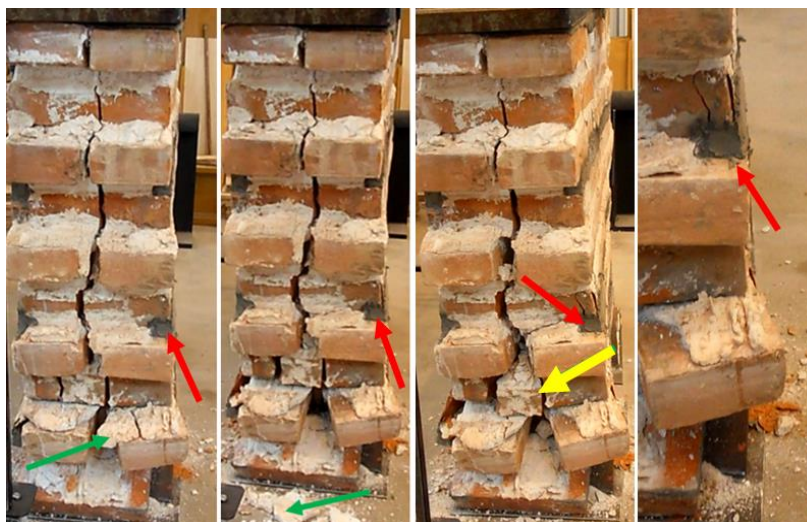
Widok zniszczeń nad lewą podporą muru (ściana przednia i tylna)
